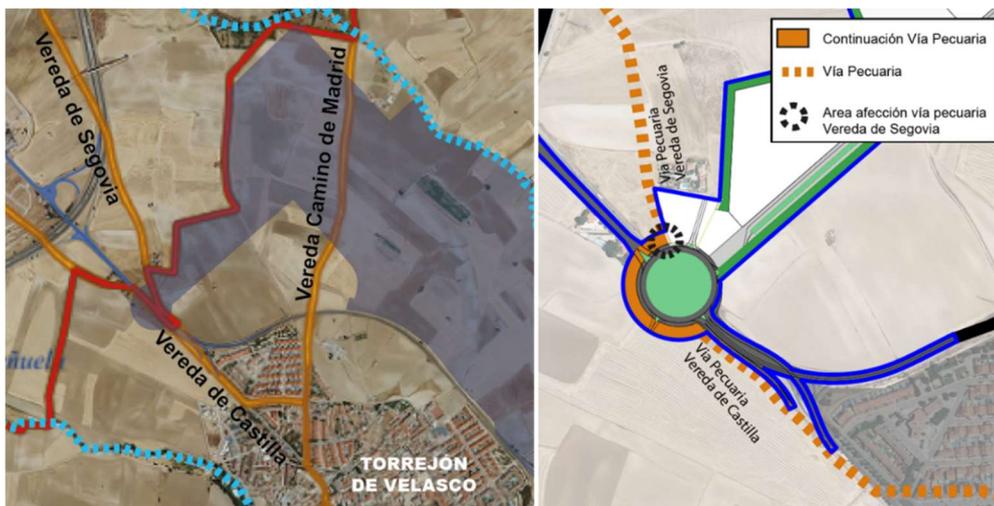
Plano vía pecuaria en su encuentro con la rotonda de acceso.
